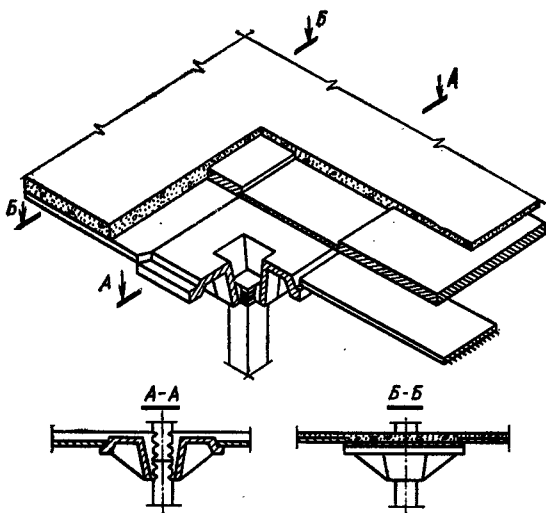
Конструкция безбалочного сборно-монолитного перекрытия
